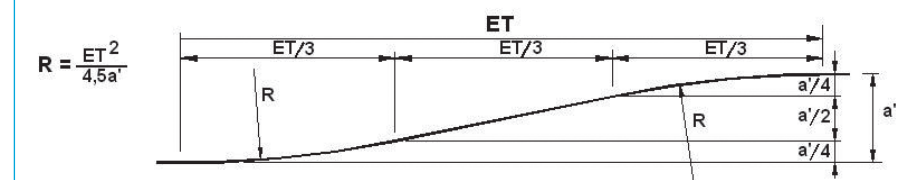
Pormenor da transição entre perfis transversais (JAE P5/90)
